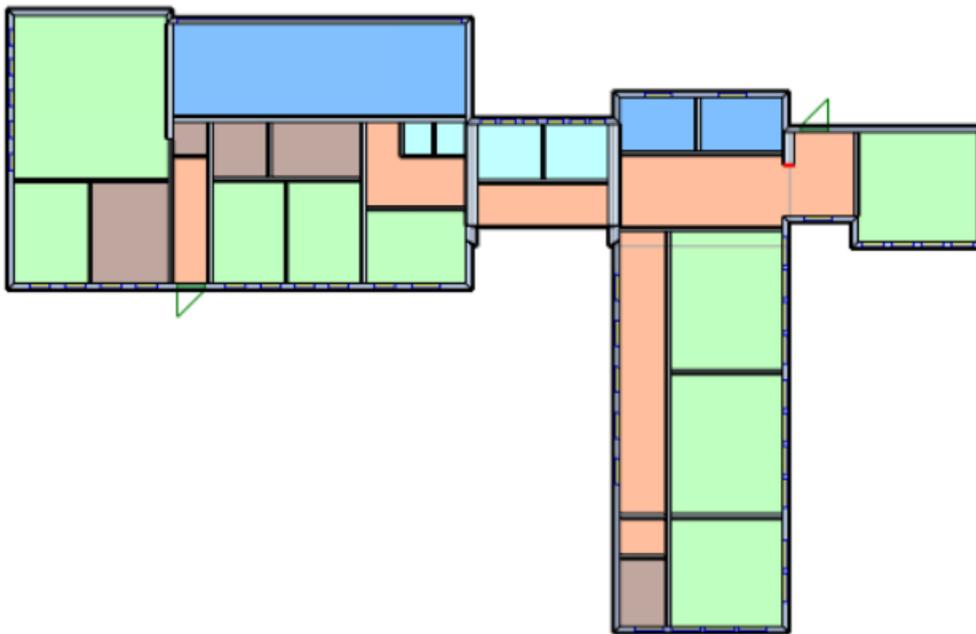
Grundriss Erdgeschoss, zониert
